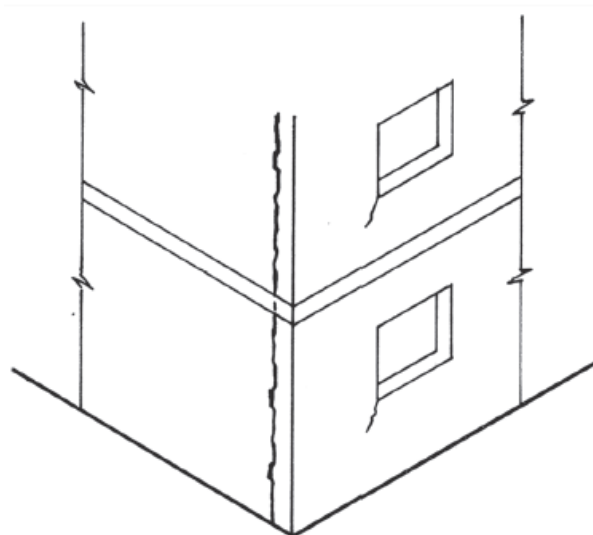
Fissuramento vertical da alvenaria, pela expansão dos tijolos por absorção de umidade
